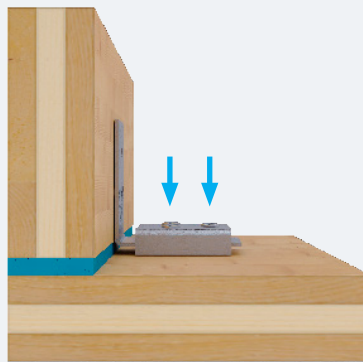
Diferentes orientaciones de instalación de Straviwood WallBracket.
